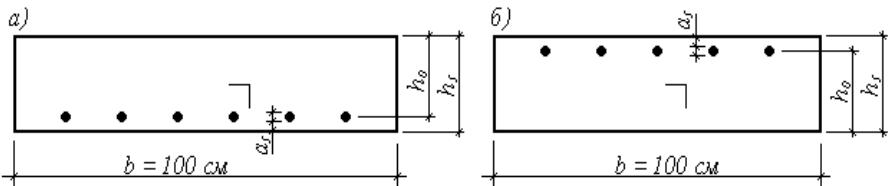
Розрахункові перерізи плити: а) в прольоті; б) на опорі
